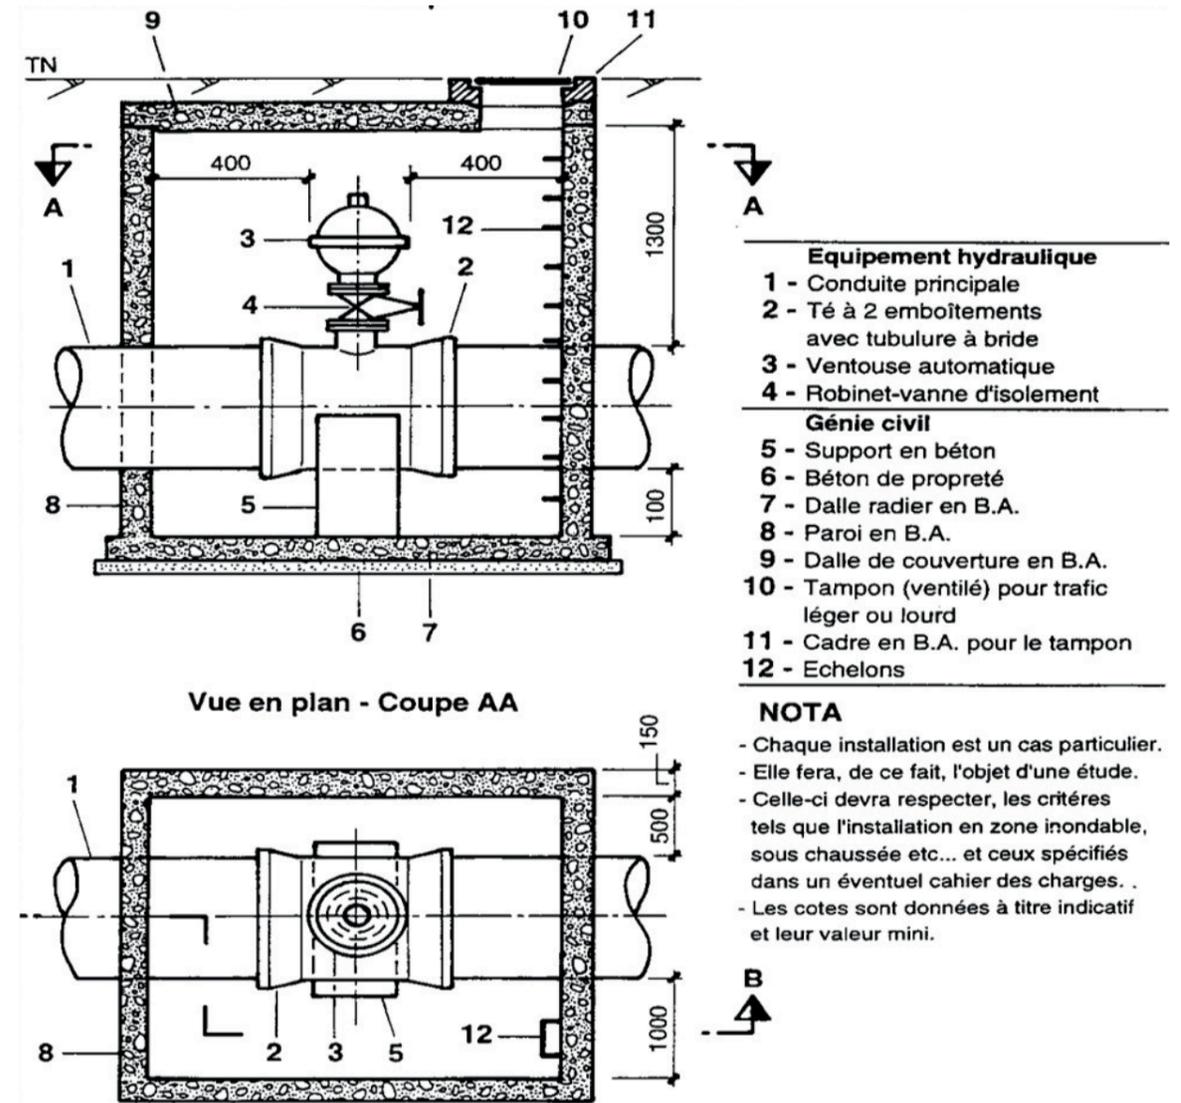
COUPE SUR REGARDS POUR VENTOUSE
